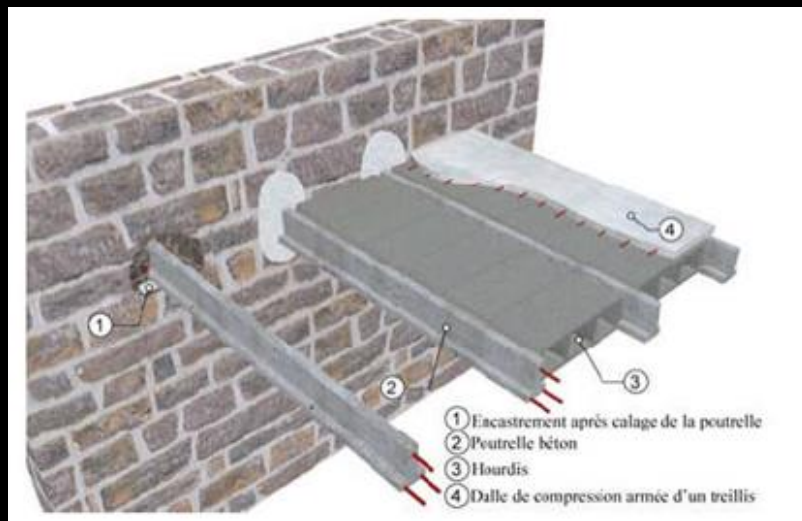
Plancher à poutrelle en béton armé encastree dans le mur
